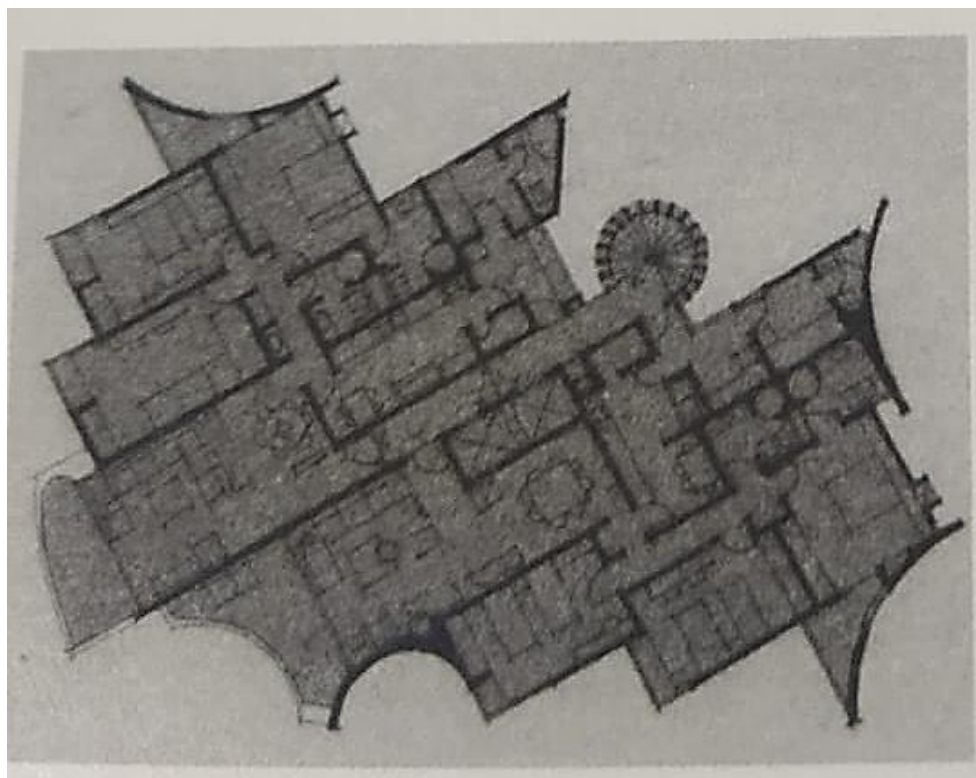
Edifício Portinari, 1969, planta tipo. Fonte: Naslavsky (2012, p. 154).
